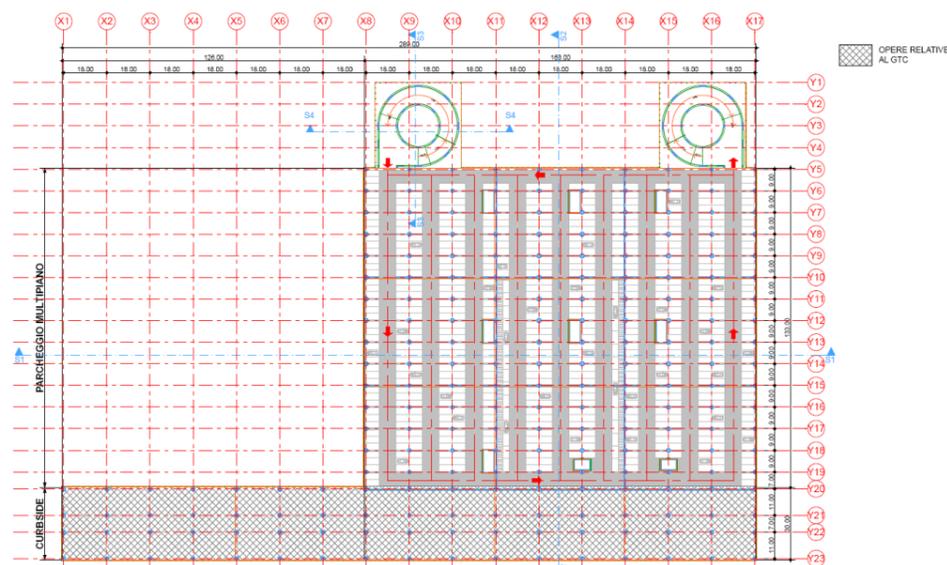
Pianta piano tipo (1° - 2° - 3°)
